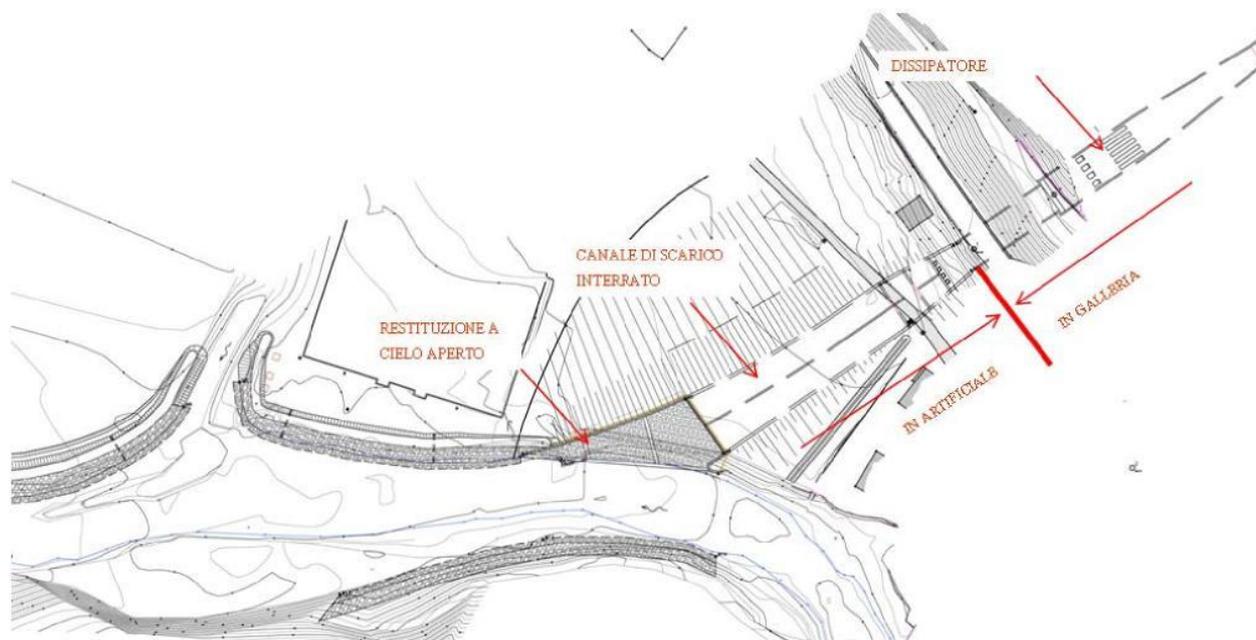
Planimetria manufatto di dissipazione, di scarico e di restituzione nel PD
